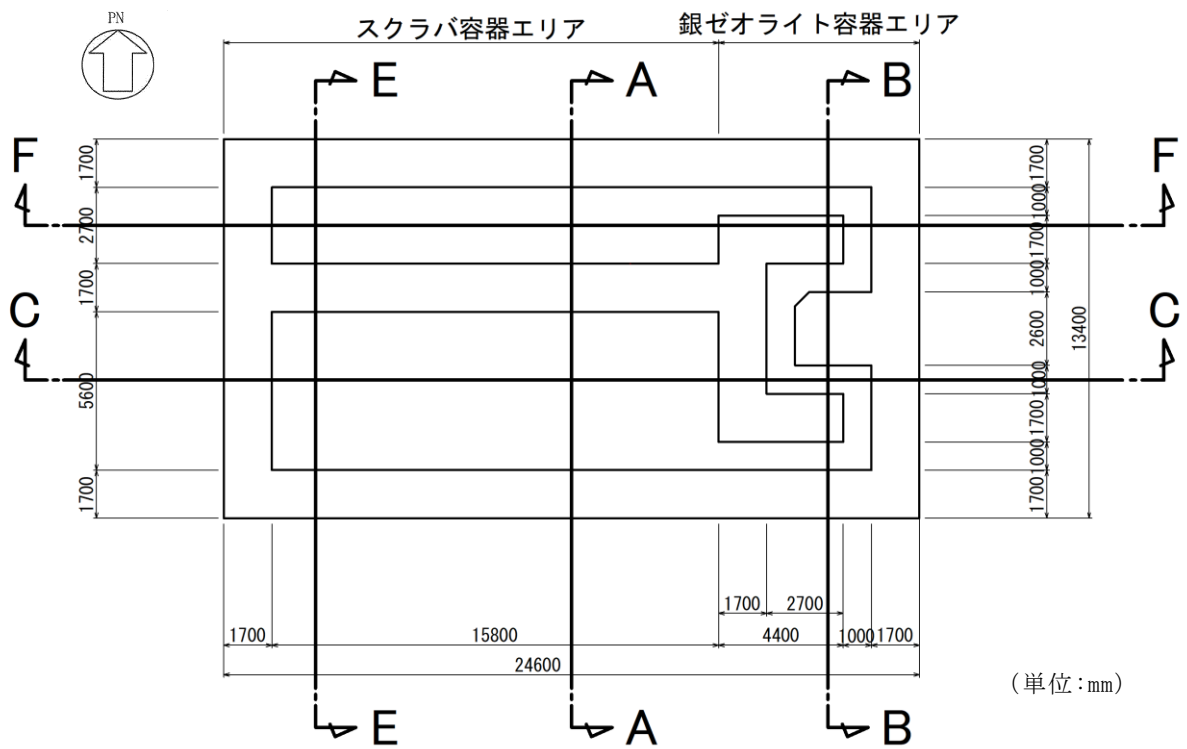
(1) 第 1 ベントフィルタ格納槽 平面図 (EL 3.00m)
